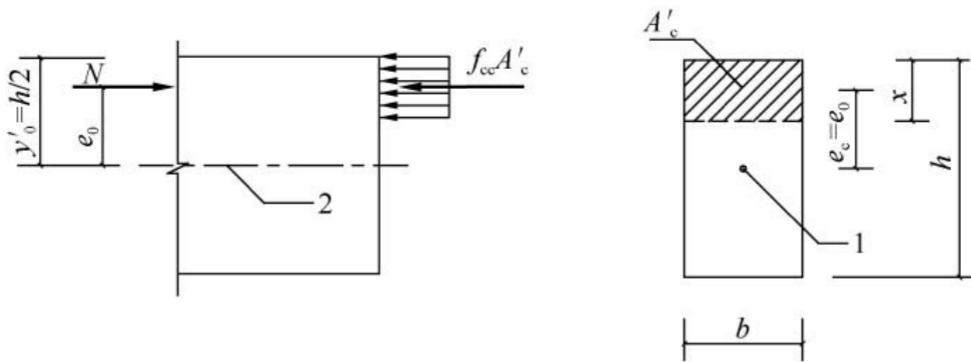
1 矩形截面的素混凝土受压构件受压承载力计算
